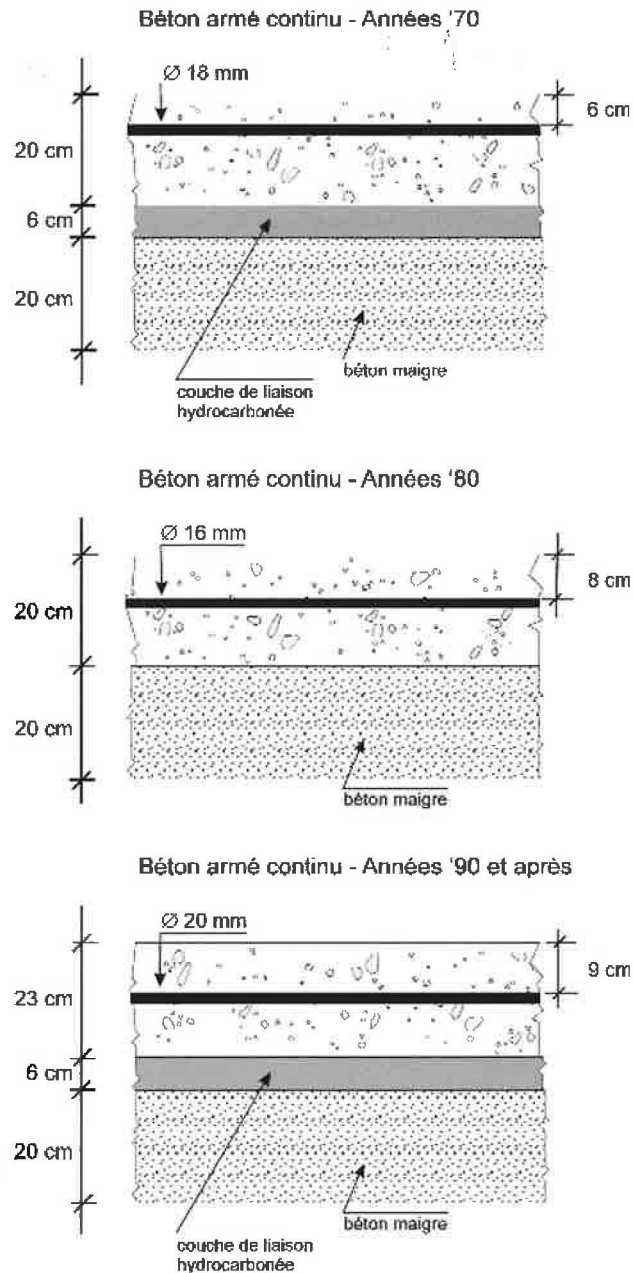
Evolution des structures en béton armé continu en Belgique et distance entre la surface du revêtement et le nu supérieur des armatures longitudinales
